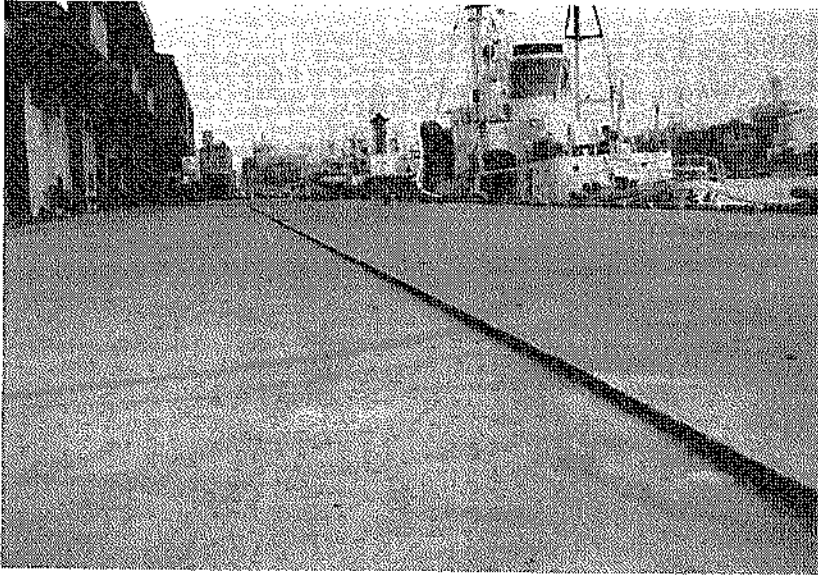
中央埠頭地区, ㊦第5バース(-7.5m)
